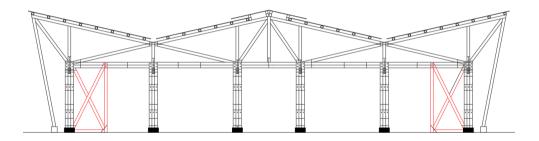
Secciones de Arriostramientos en Vista Transversal. Fuente: [Propia]
